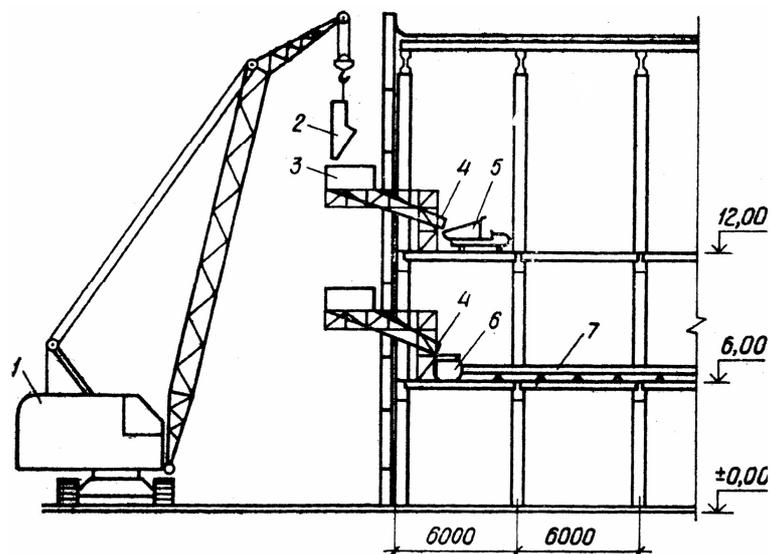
Подача бетонной смеси стреловым краном через монтажные проемы: 1 – стреловой кран; 2 – поворотный бункер; 3 – приемный бункер; 4 – раздаточное устройство; 5 – мототележка; 6 – бетононасос; 7 – бетоновод
